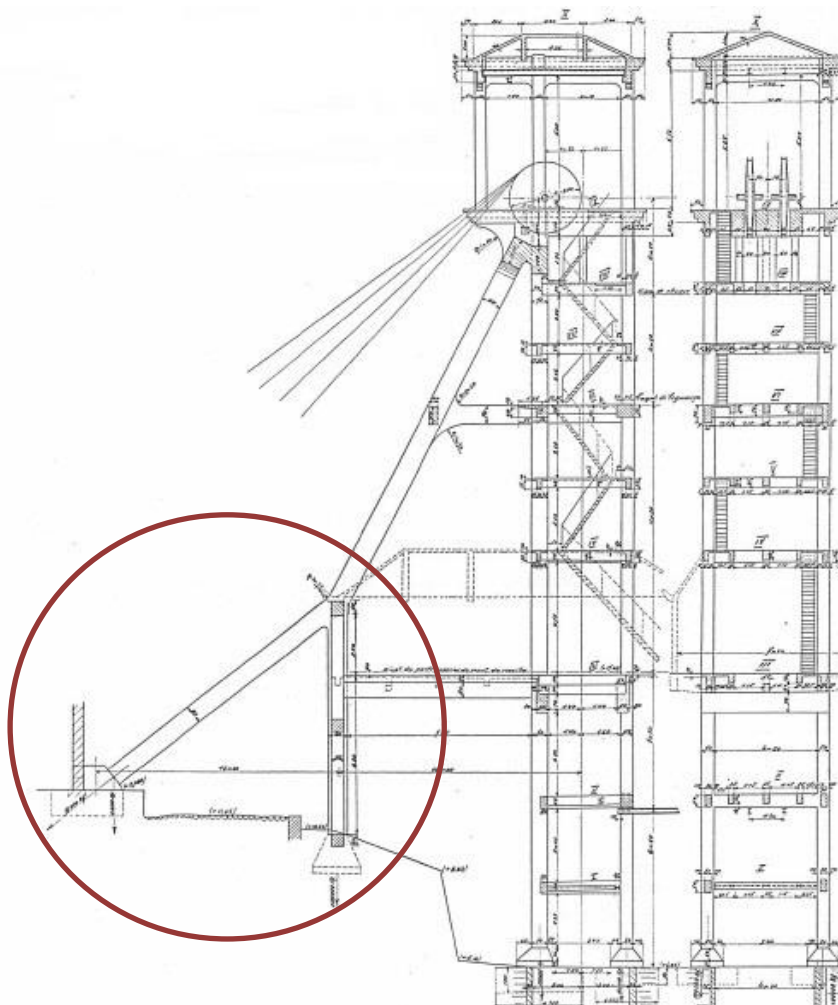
Corte transversal do Cavalete de S. Vicente – adaptado de Almeida (1940)
